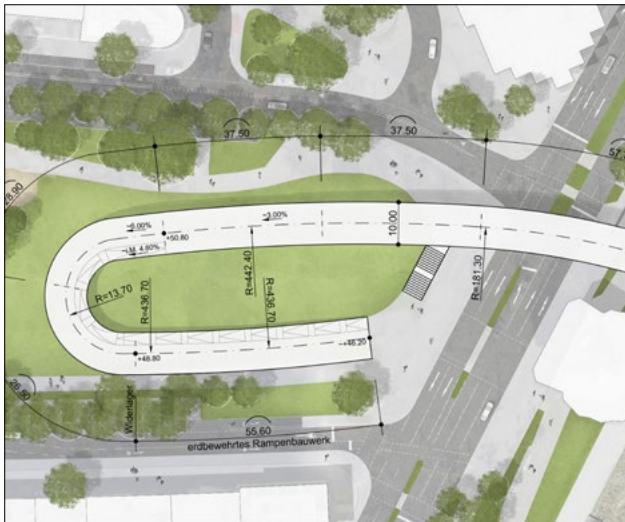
Grundriss linksrheinische Rampe
